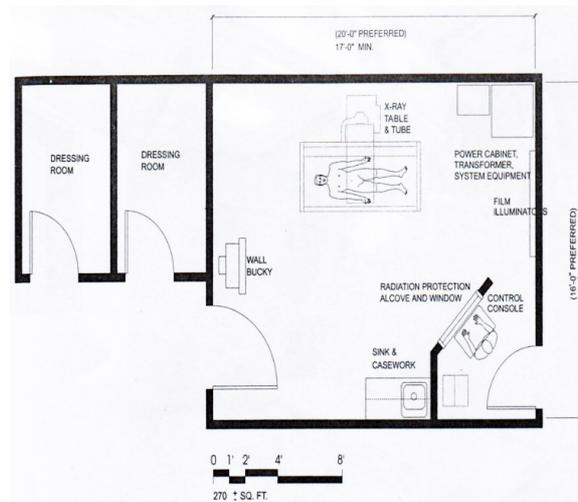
Exemplo de planta baixa de uma sala de Raio-X. Fonte: KOBUS et al, 2008.
